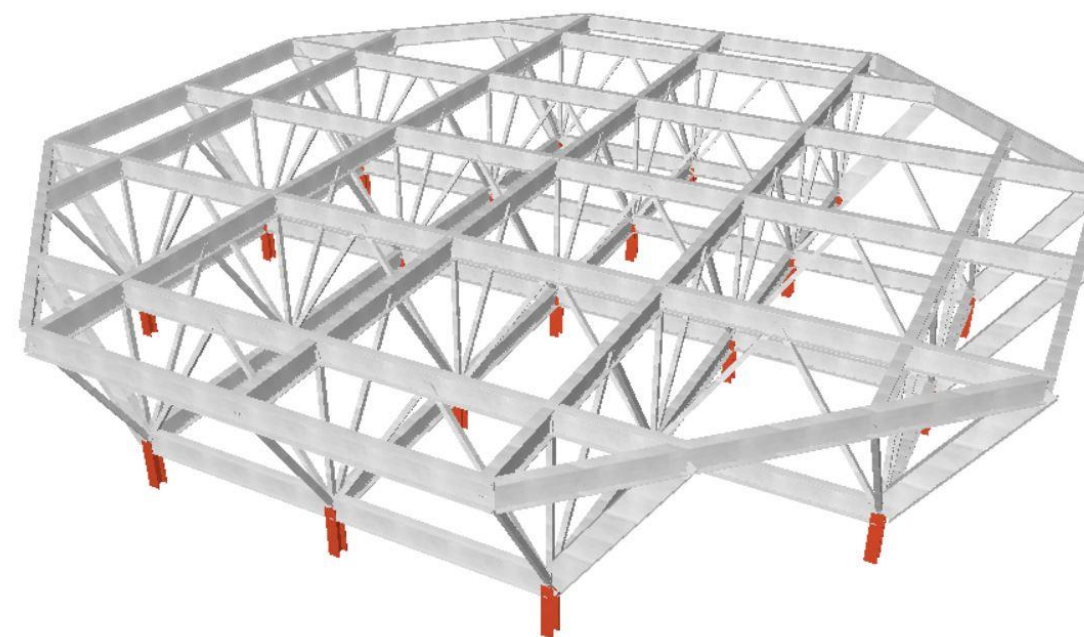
Estructura en celosía de aluminio y unión con los pilares HEB. Fuente: Propia.
